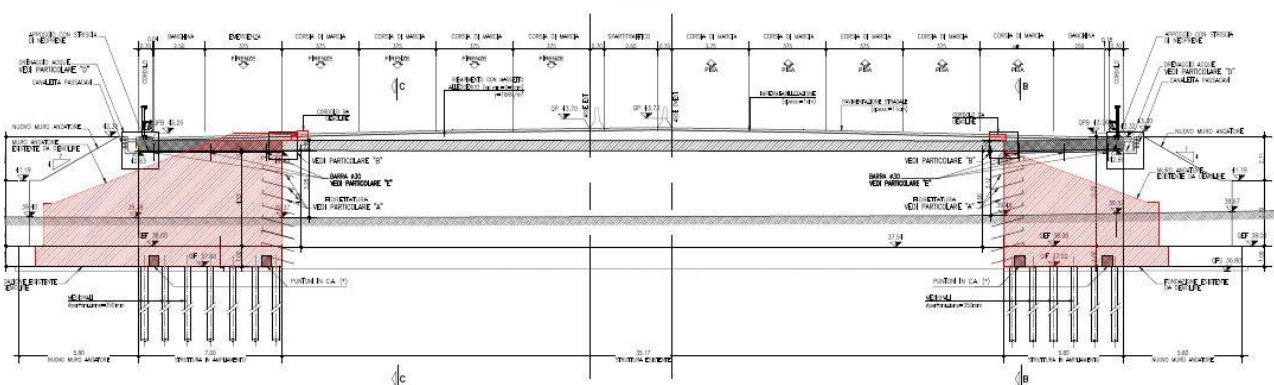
Sezioni tipo progetto ampliamento sottovia.
